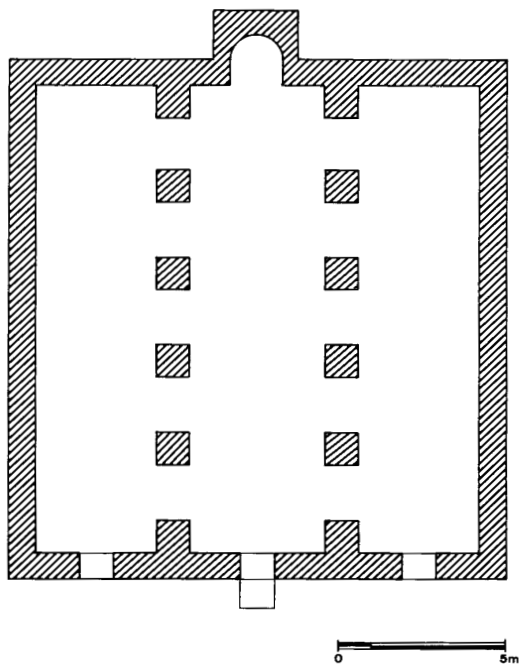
Reconstrucción de la planta del edificio de la planta basilical del Cabezo de Miranda de Juslibol (Zaragoza), según ASENSIO (1998).
